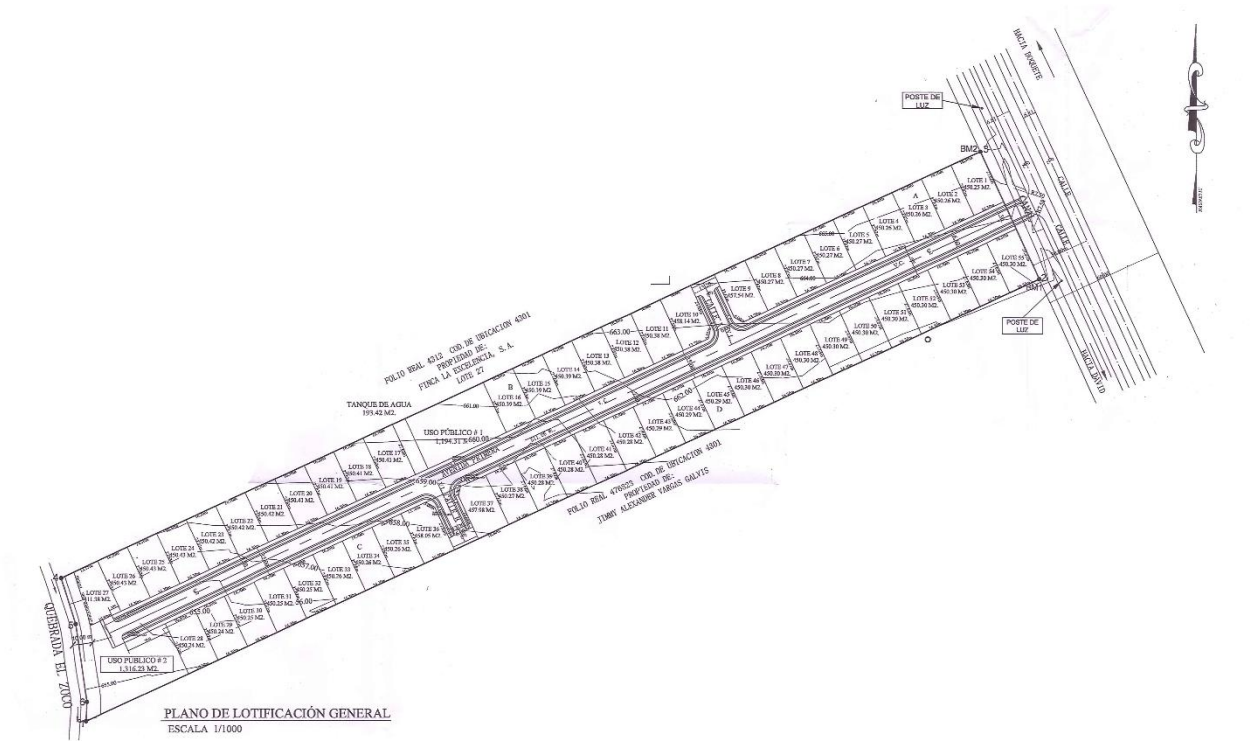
Planta general del proyecto URBANIZACIÓN BOQUETE PARK
